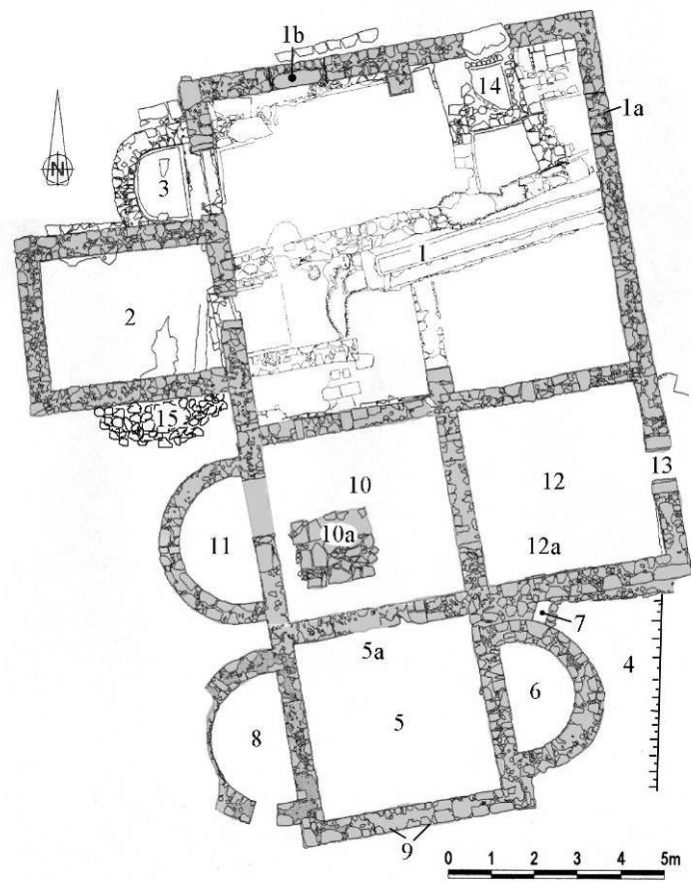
Planta do edifício das Termas Sul. Estruturas da 3ª fase.
